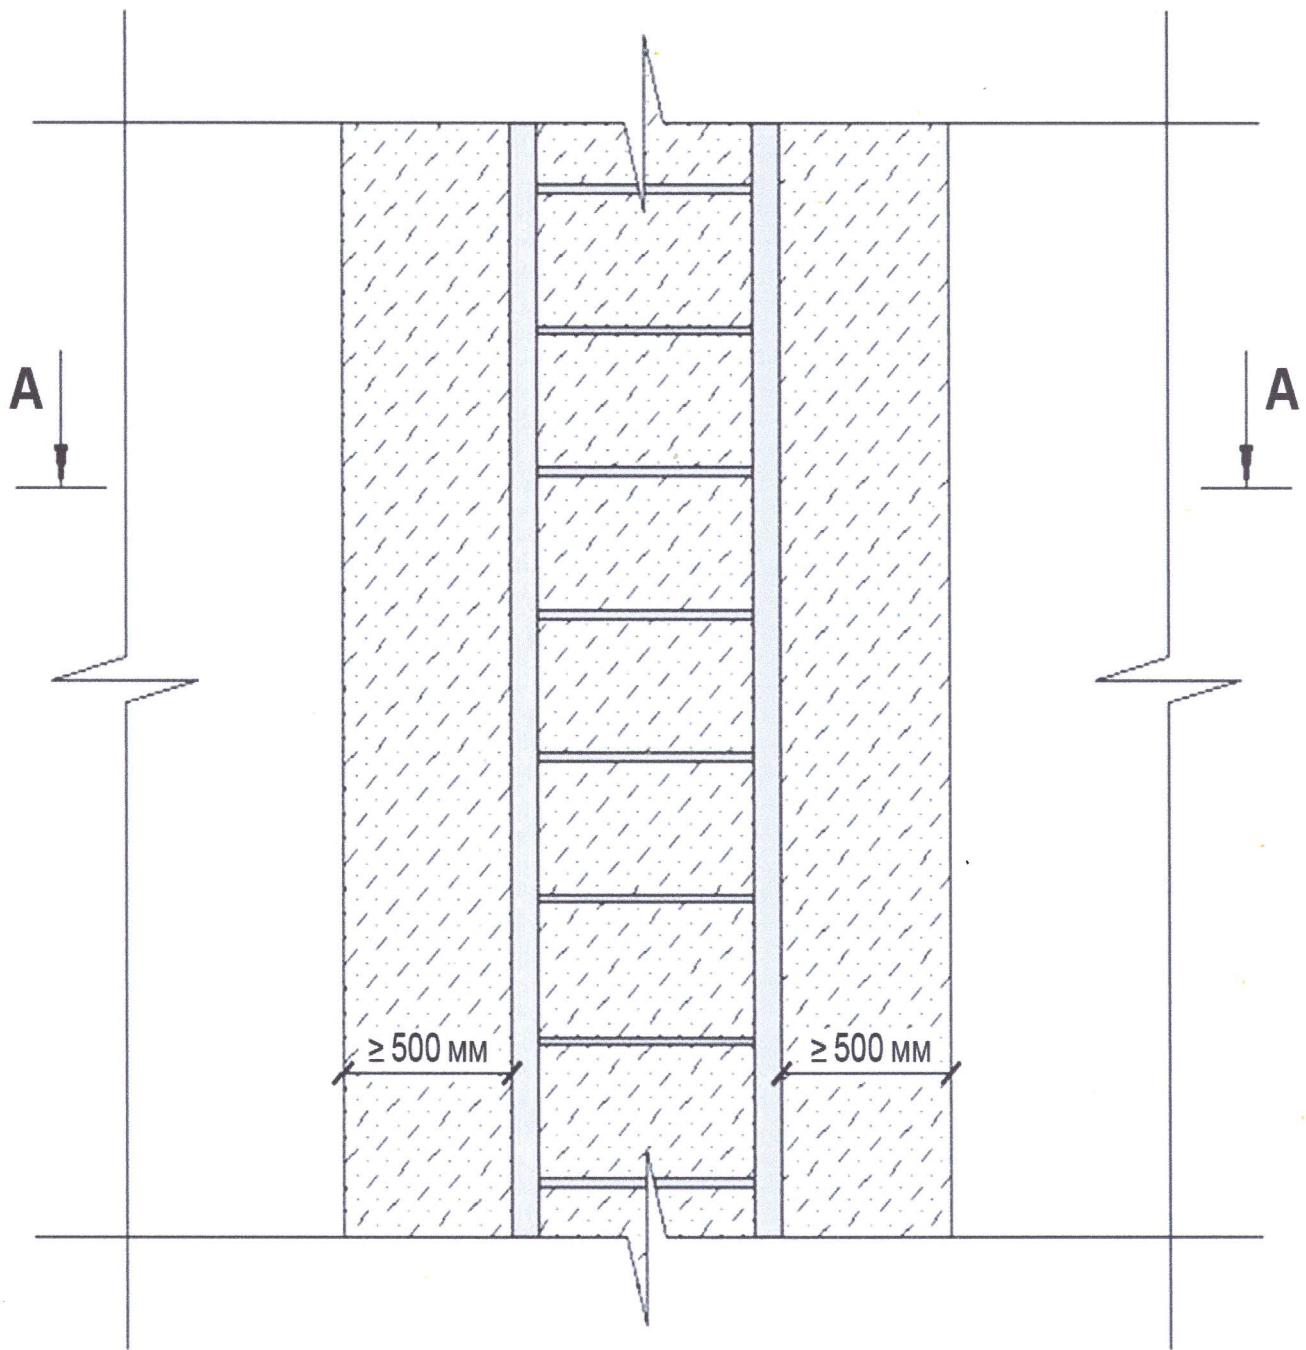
Участки примыкания СФТК к пожарной или наружной маршевой лестнице здания
